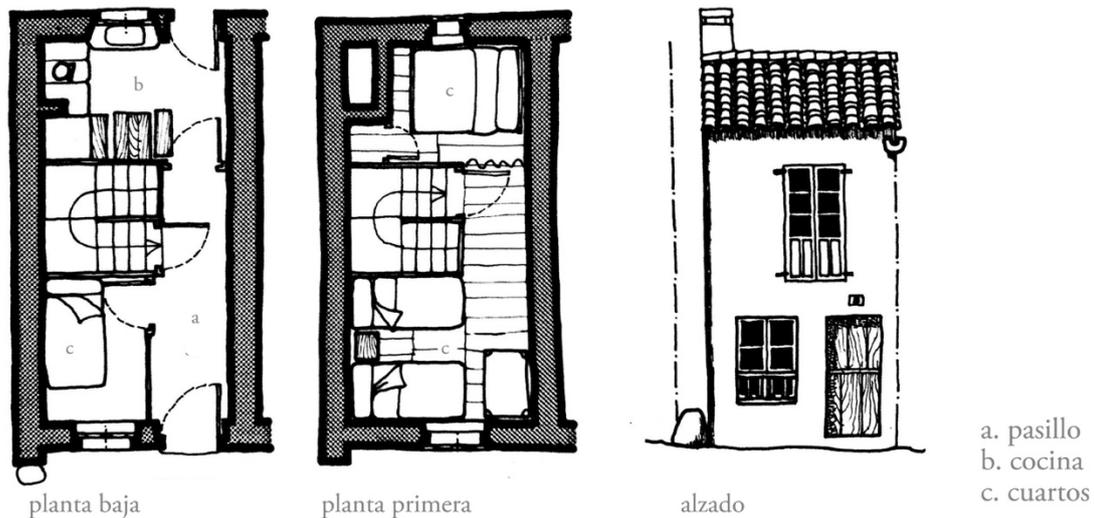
Planta y alzado de vivienda entre medianeras en Baiona (Pontevedra)
